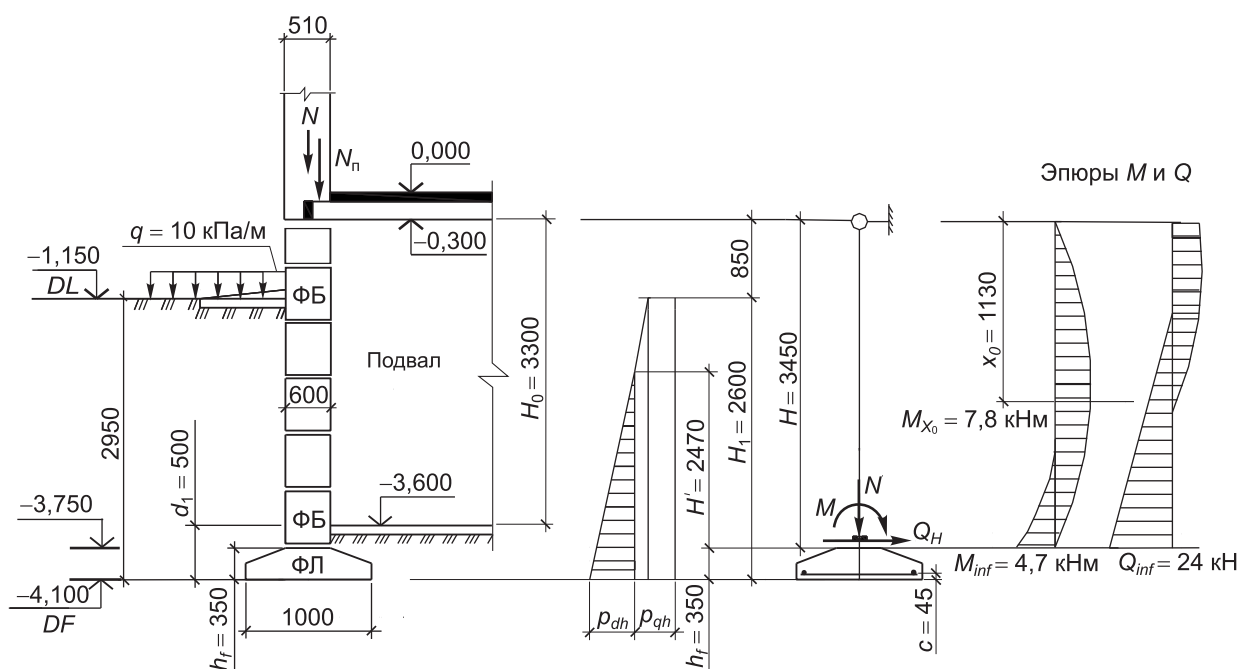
Расчетная схема и конструкция фундамента к примеру Г.6
